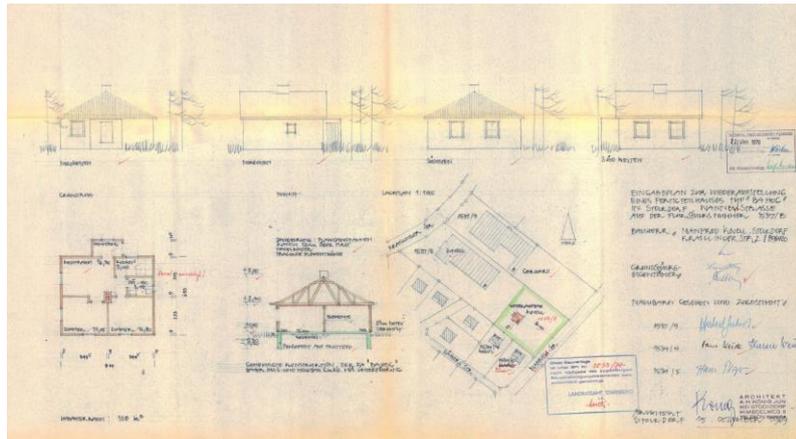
Genehmigungsplang für bestehendes Gartenhaus, Quelle: Gemeinde Gauting
